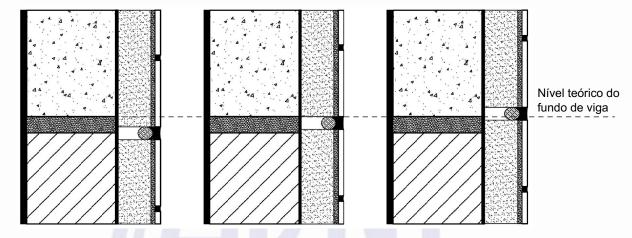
Posições da junta de movimentação em relação ao fundo de viga
